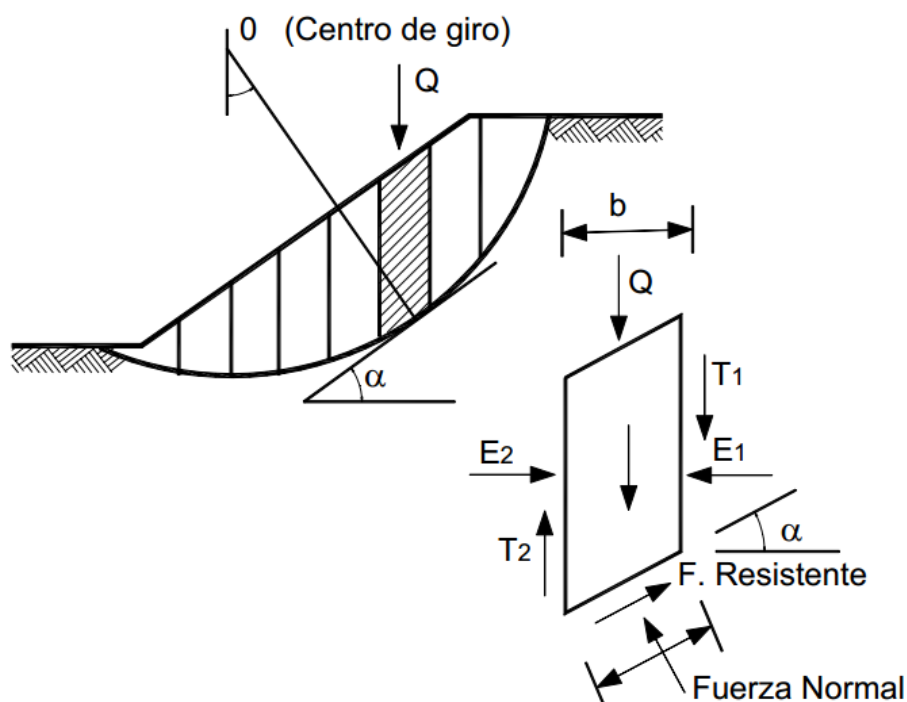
Fuerzas que actúan sobre una dovela.
